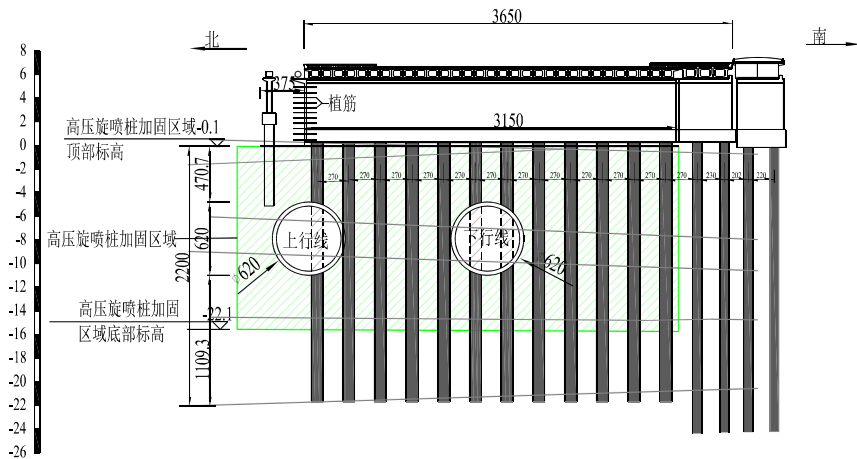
盾构隧道穿越桥梁桩基断面图 (加固后) (单位: cm)
